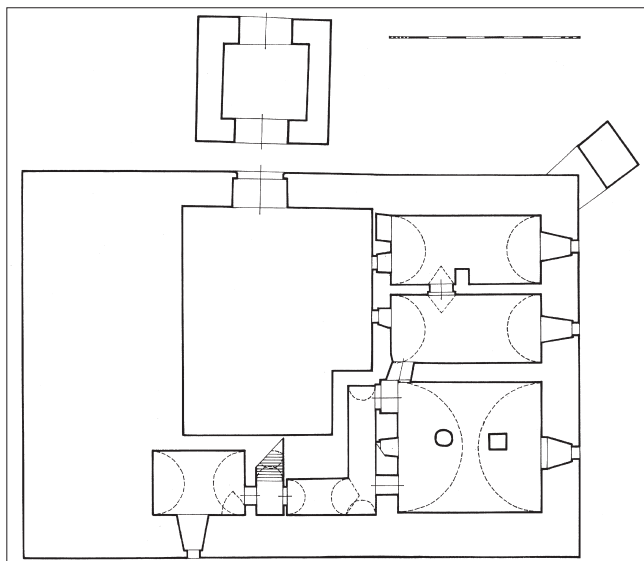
Jeseník, zámek, celkový půdorys se zakreslením úrovně sklepů, stav v roce 2006. Zaměření Pavel Kouřil, Dalibor Prix, vynesení Dalibor Prix.
